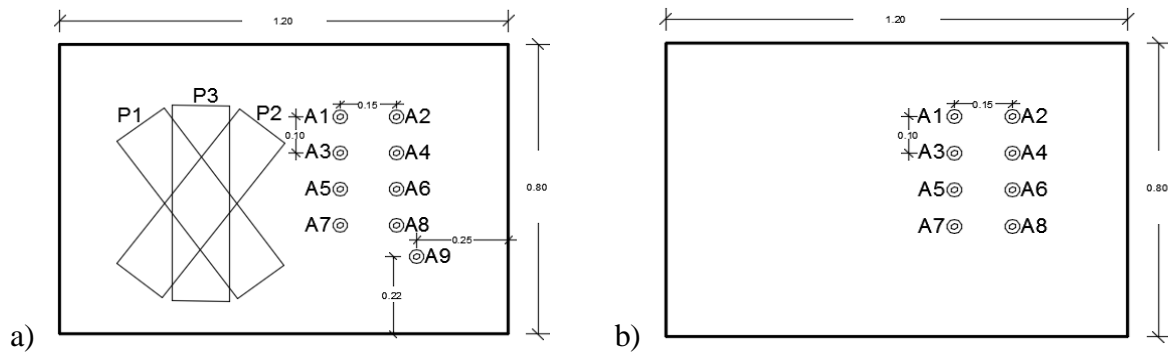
Configuração das posições de fonte (P1 a P3) e posições do acelerómetro: a) face superior do pavimento de referência (A1 a A9) b) face inferior do pavimento de referência (A1 a A8).
